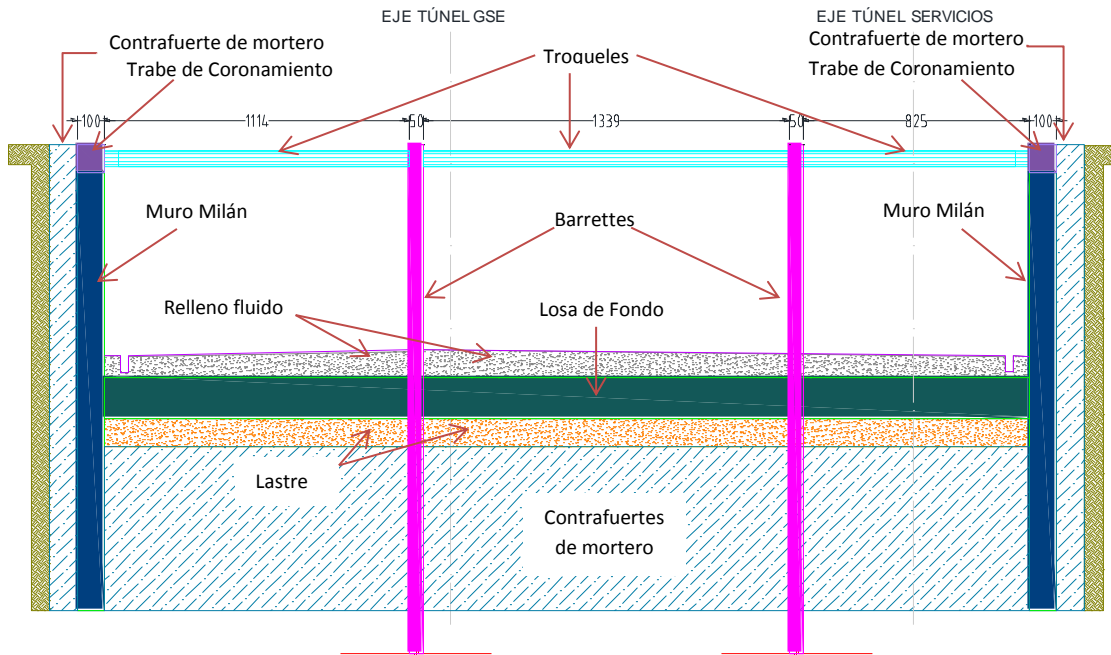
Nivel Máximo de Excavación – Colocación de lastre, losa de fondo y relleno fluido.
